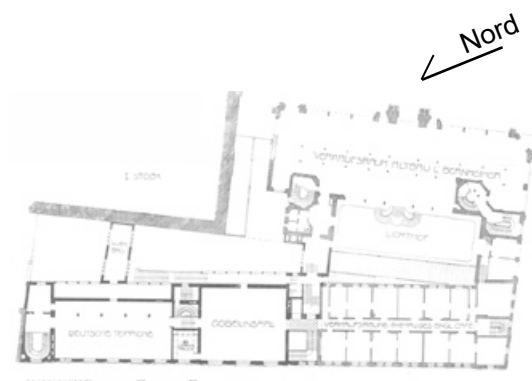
Grundriss EG (DBZ 1910, S. 445).
